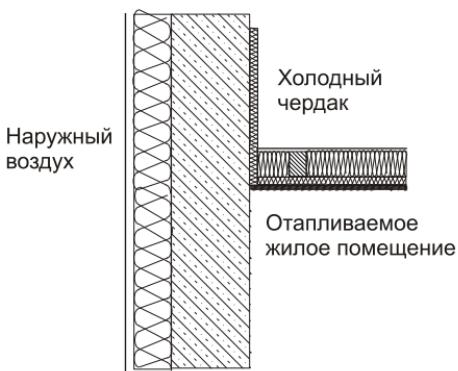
Устранение "теплового мостика" в месте стыка наружной стены с чердачным перекрытием за счет установки вертикальной внутренней теплоизоляции в чердачном помещении
